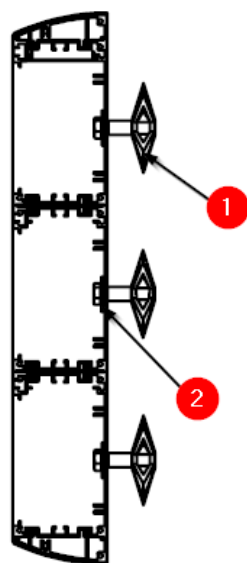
Befestigung des Geräts an einer Gipskartonwand
